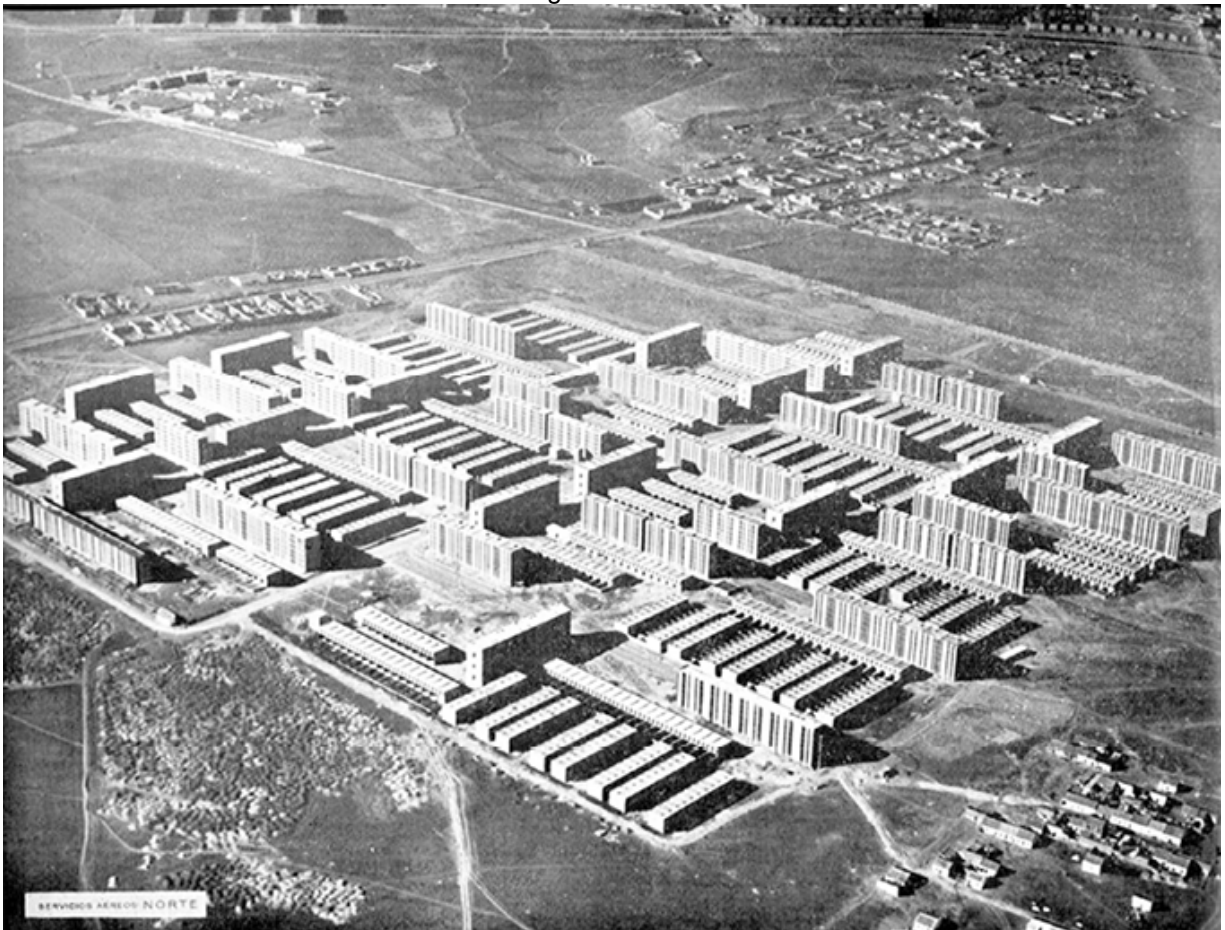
Plan de Vivienda Nacional del Instituto Nacional de Vivienda.
